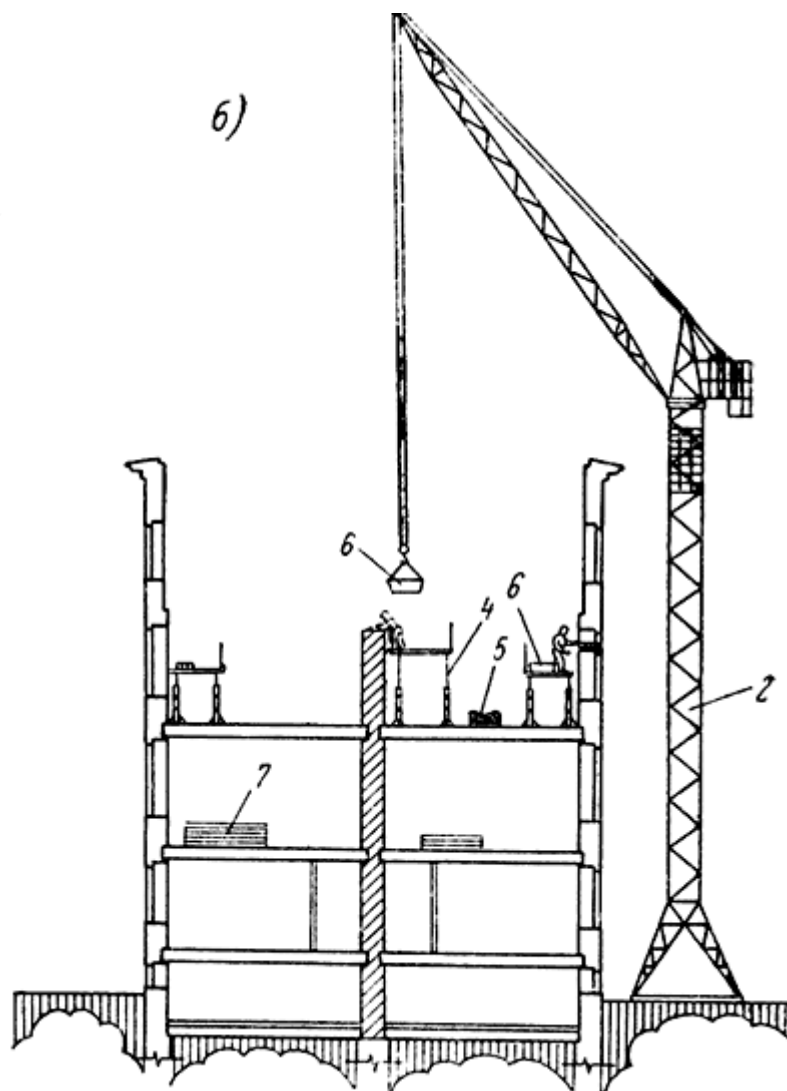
Общая схема организации работ по перекладке участка стены при комплексном капитальном ремонте жилого дома
